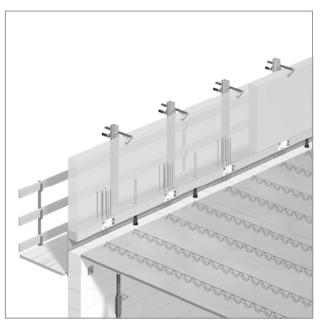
Schöck Isokorb® XT tipo A con soporte de montaje Combar® FT: Fijación del peto prefabricado alineado
